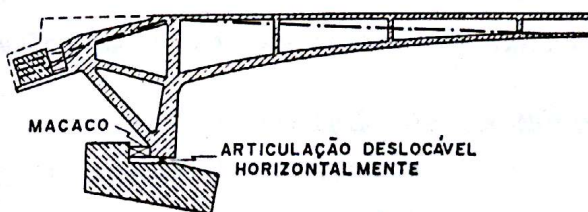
PÓRTICO COM PILAR CURTO E RÍGIDO
